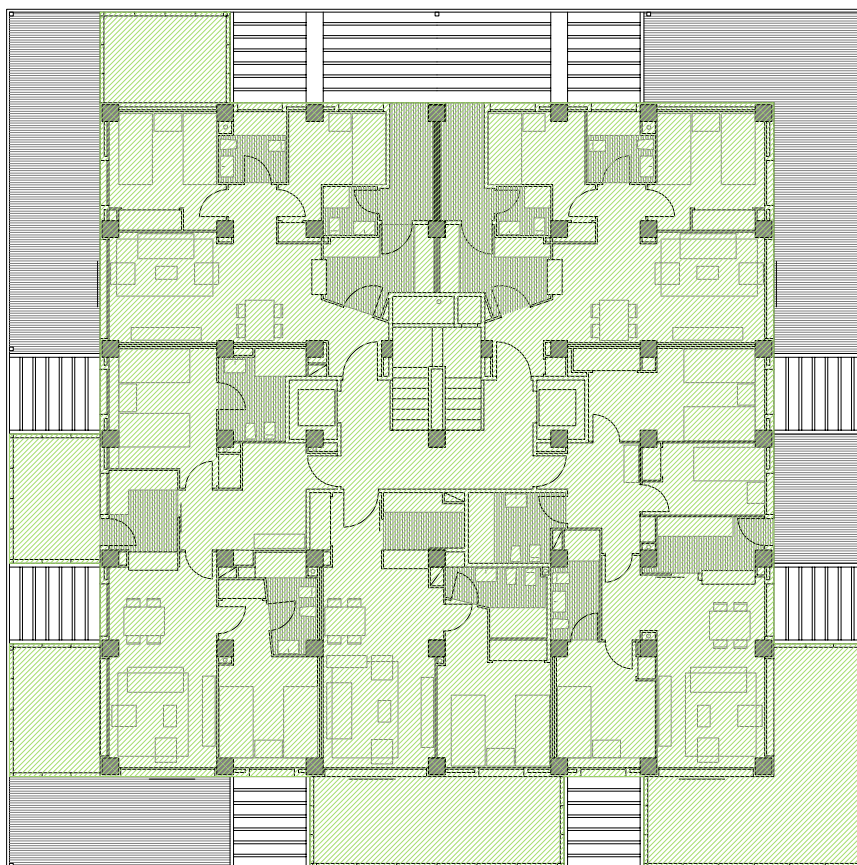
5: Distribución de tipologías Planta Tipo. Proyecto de Ejecución Torre Aisa, Antonio García Solera, 1966. Archivo Municipal de Alicante, Legajo 382_Playas, 69.
